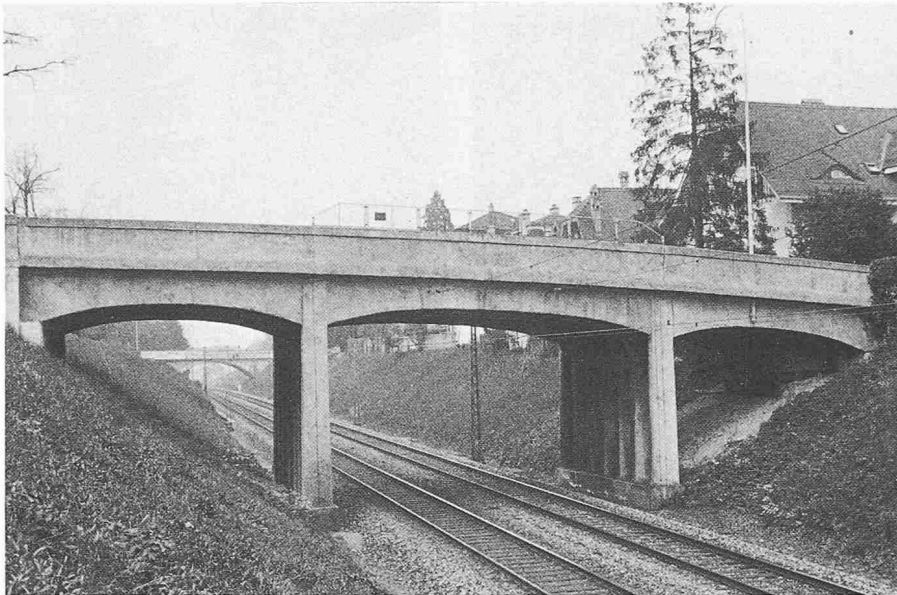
Mit Spritzbeton sanierte Stahlbetonbrücke. Betondeckung der Armierung
